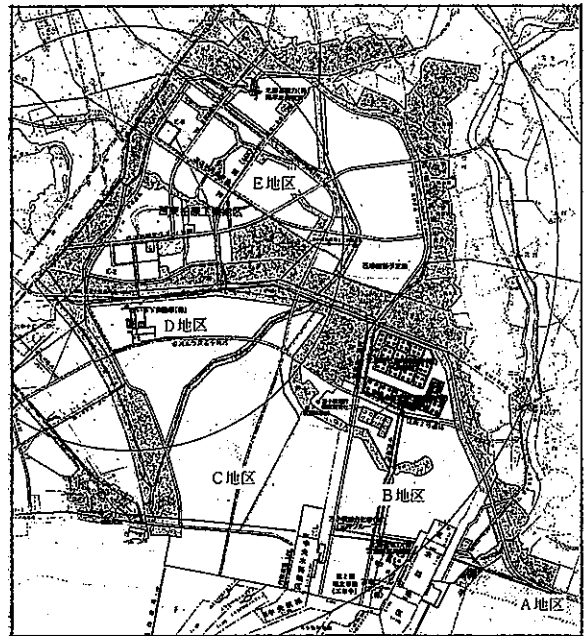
苫小牧東部工業基地開発計画平面図(陸上部抜粋)
